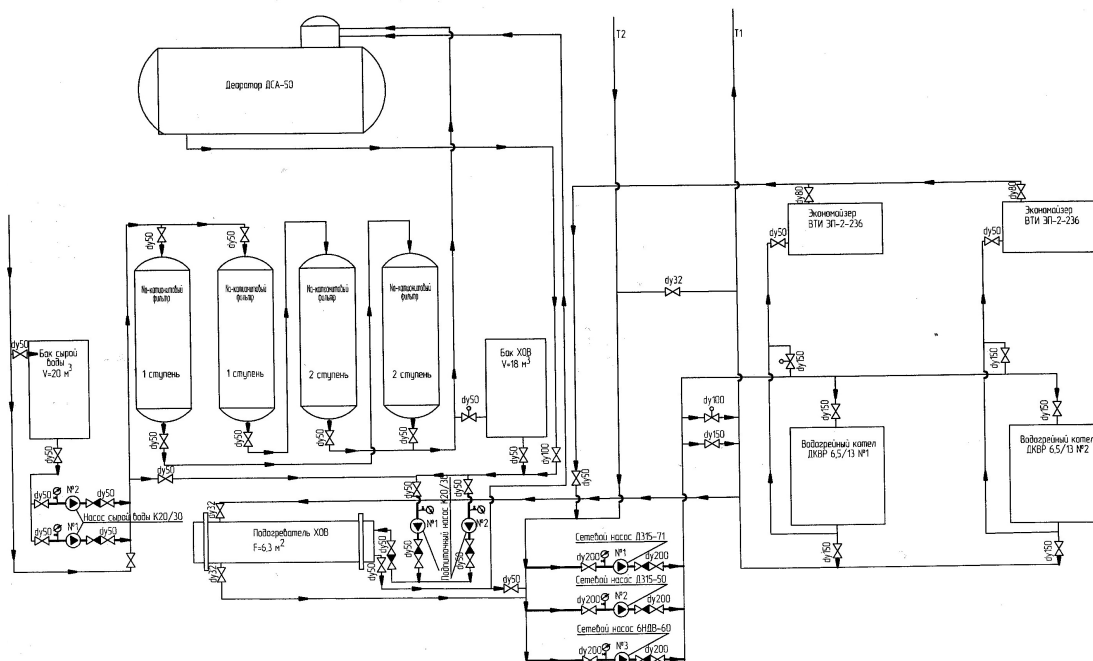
Принципиальная тепловая схема котельной №7
